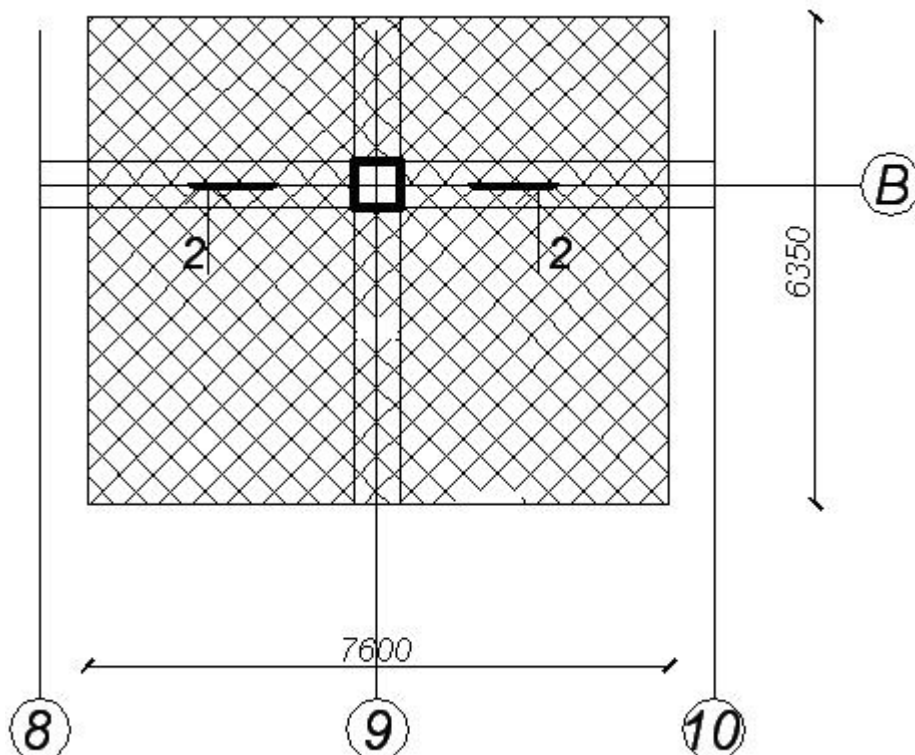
Площа розподілу навантажень на фундамент
